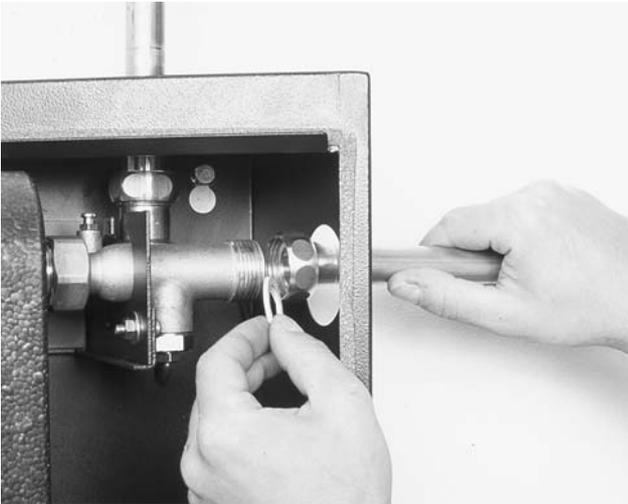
Warmwasser anschließen. Gut dämmen. Flachdichtungen nicht vergessen !
